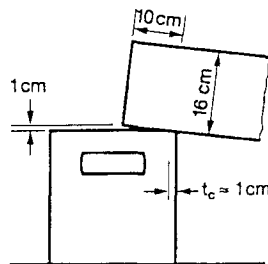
Auflager im Bruchzustand mit der eingetretenen Verdrehung der Deckenplatte und der sich einstellenden minimalen überdrückten Breite
